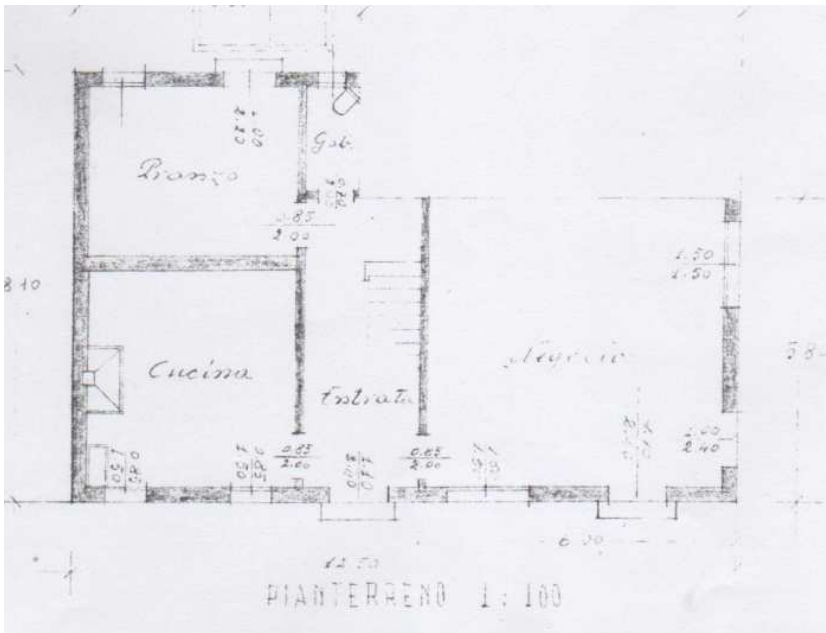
Pianta e prospetto di porzione di fabbricato (1949)
